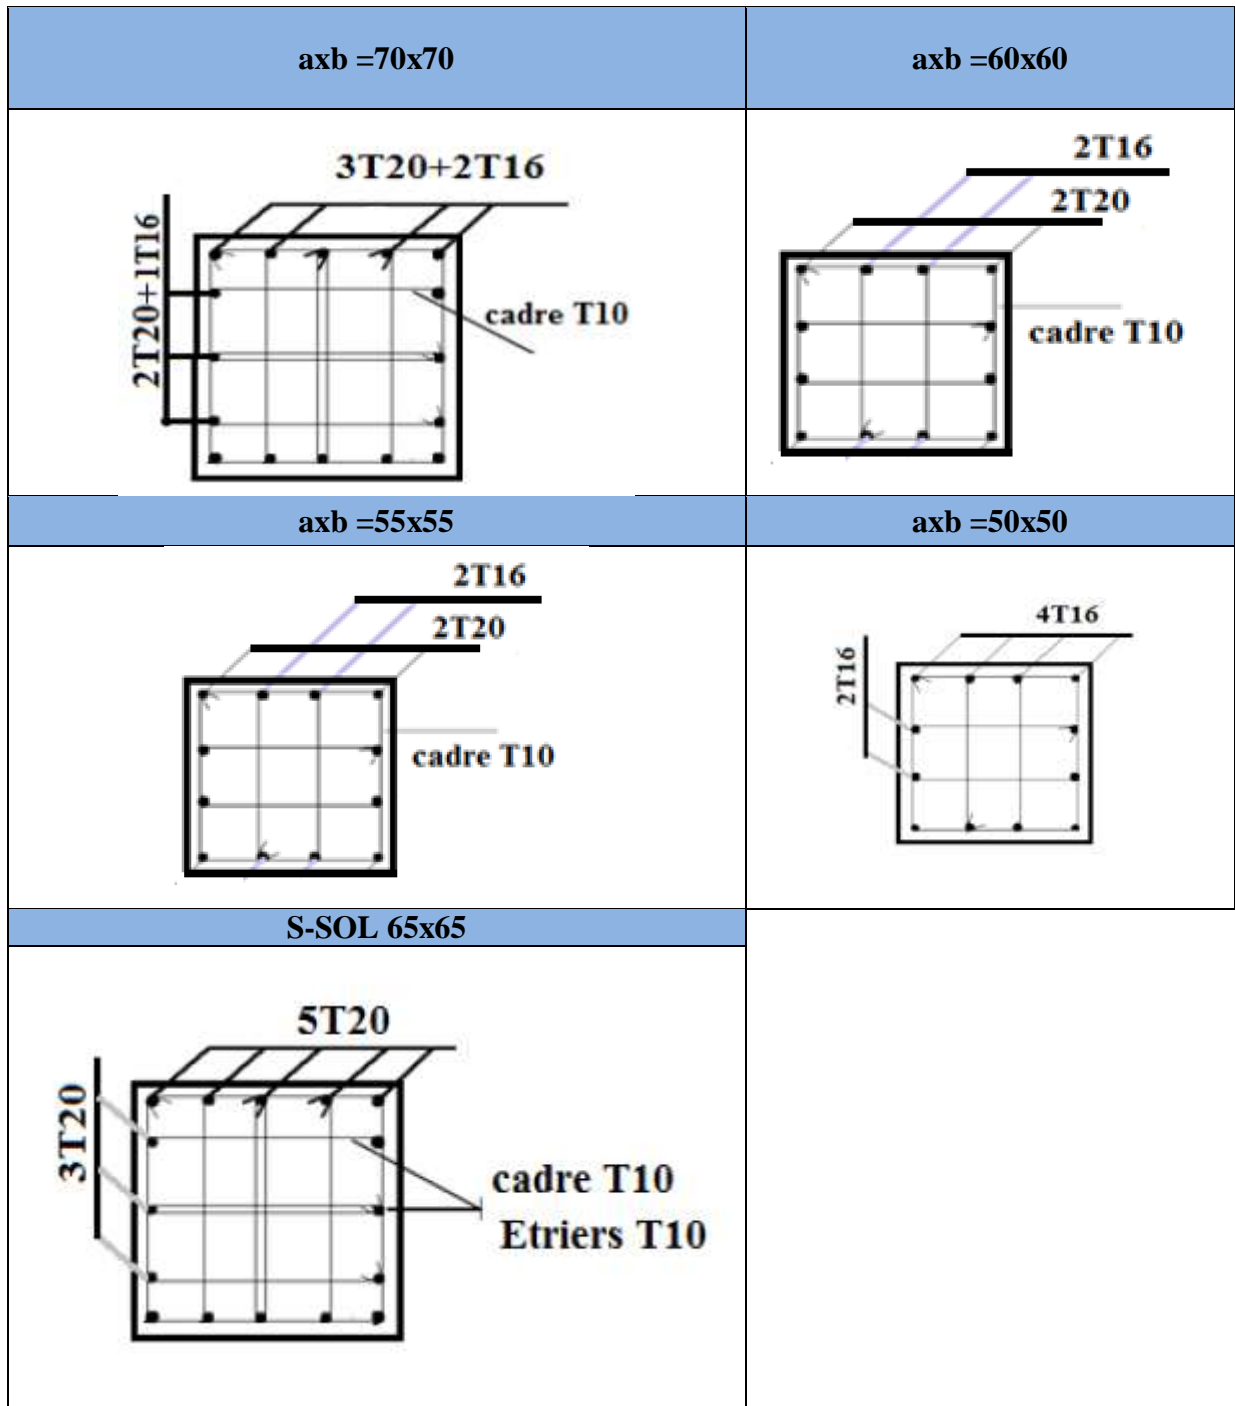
Schéma de Ferraillage des poteaux. (Bloc R+7)
